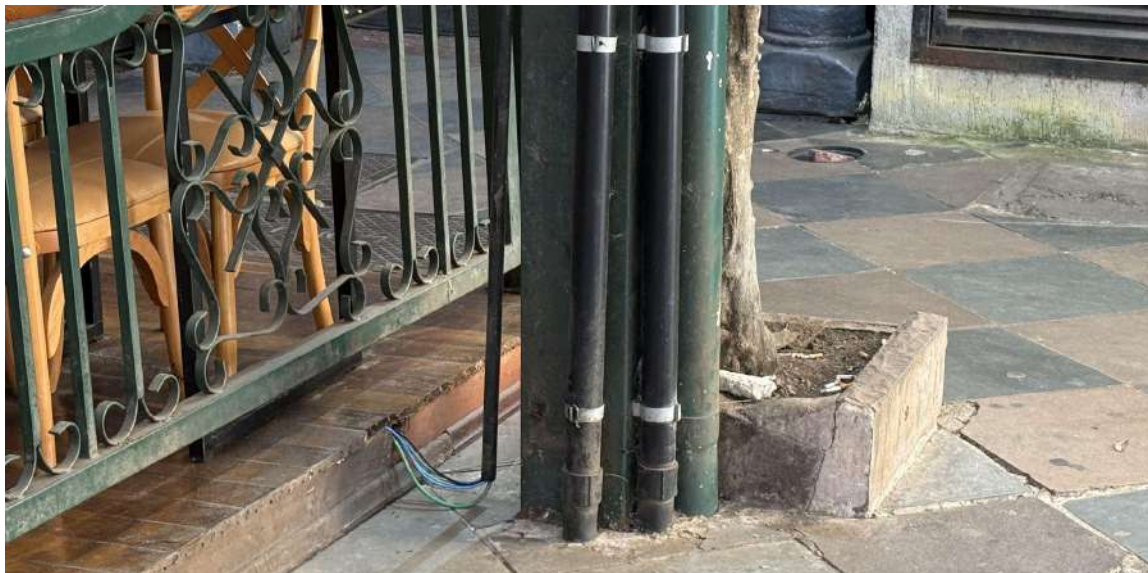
Detalhe de tubulações e fiação aparente junto à base estrutural
